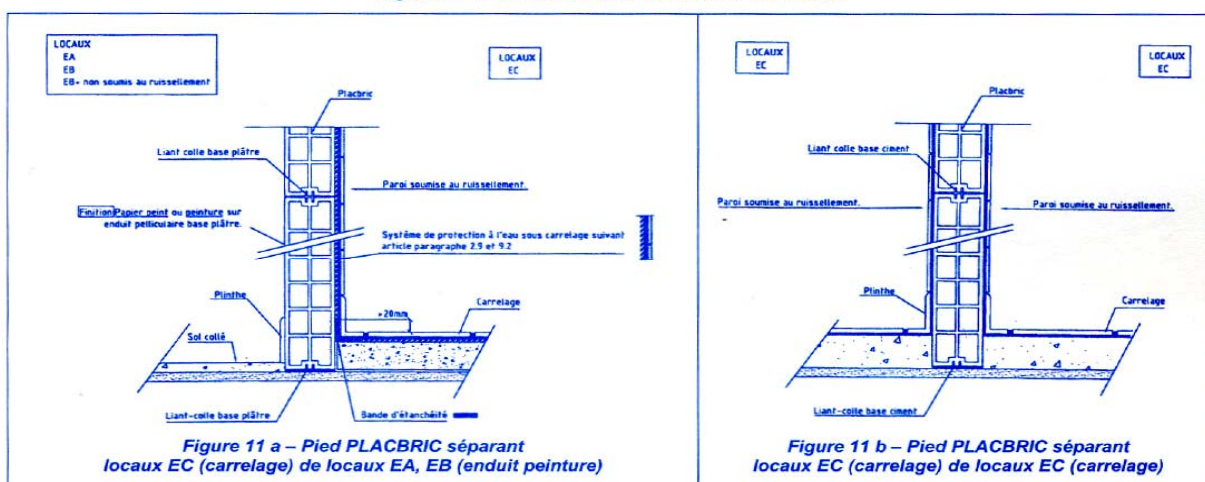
a – Pied PLACBRIC séparant locaux EC (carrelage) de locaux EA, EB (enduit peinture)
